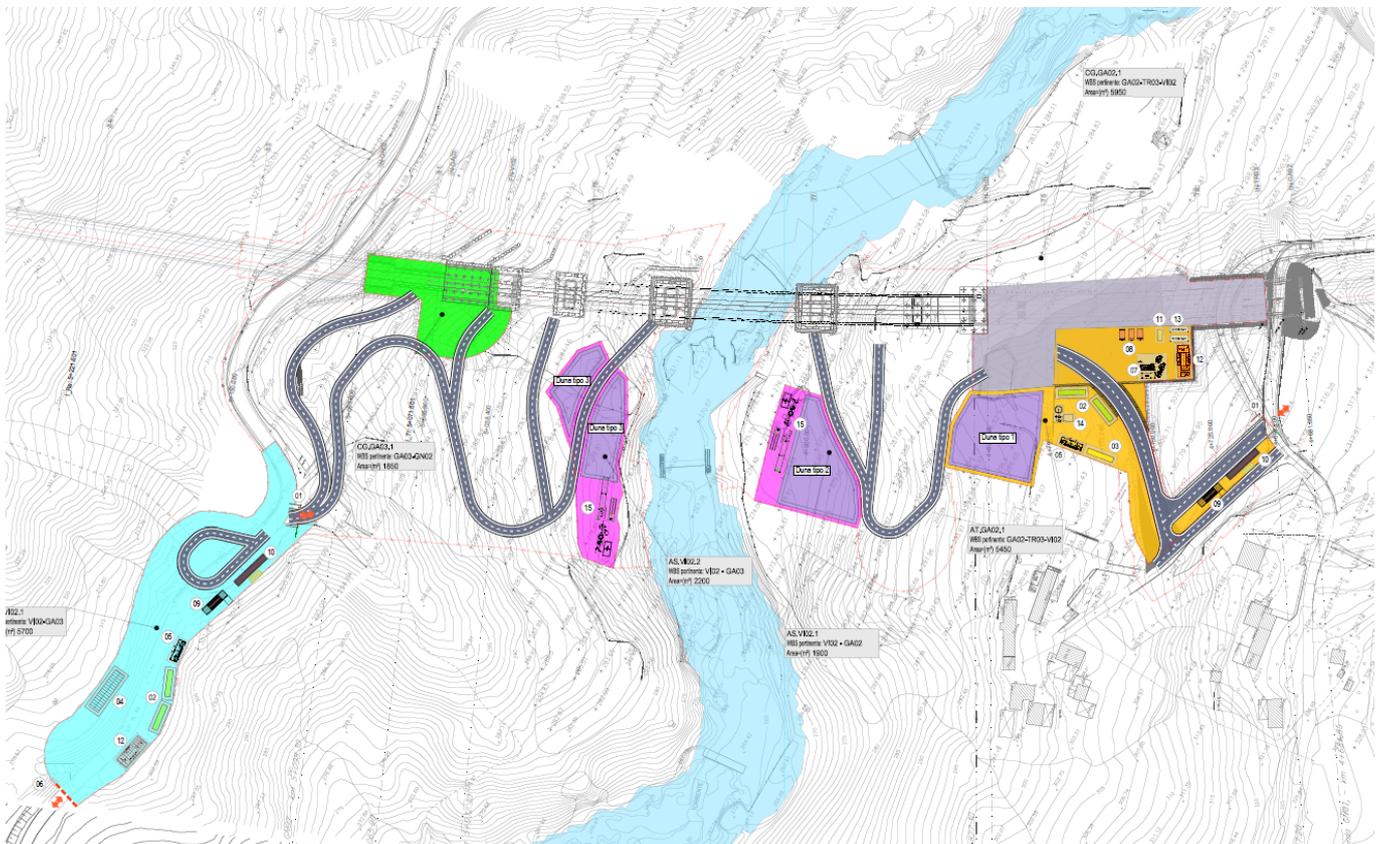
Layout cantieri VI02 – Imbocchi gallerie Rocchetta Napoli e Melito Bari
